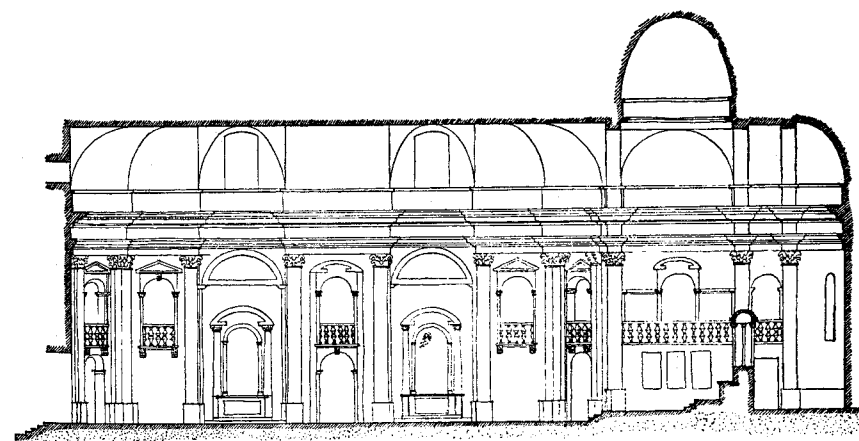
F. VECELLI, CHIESA DI SANTA CROCE, SEZIONE LONGITUDINALE, PADOVA
